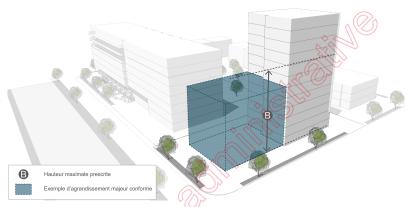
Agrandissement majeur d'une construction dérogatoire à la hauteur maximale
